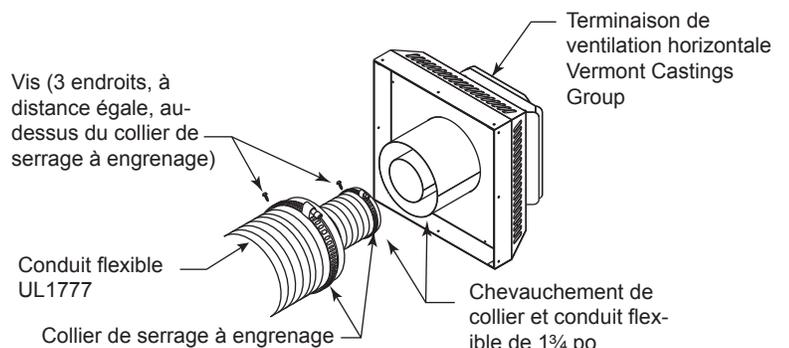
Installation typique d'un conduit de ventilation flexible horizontale
